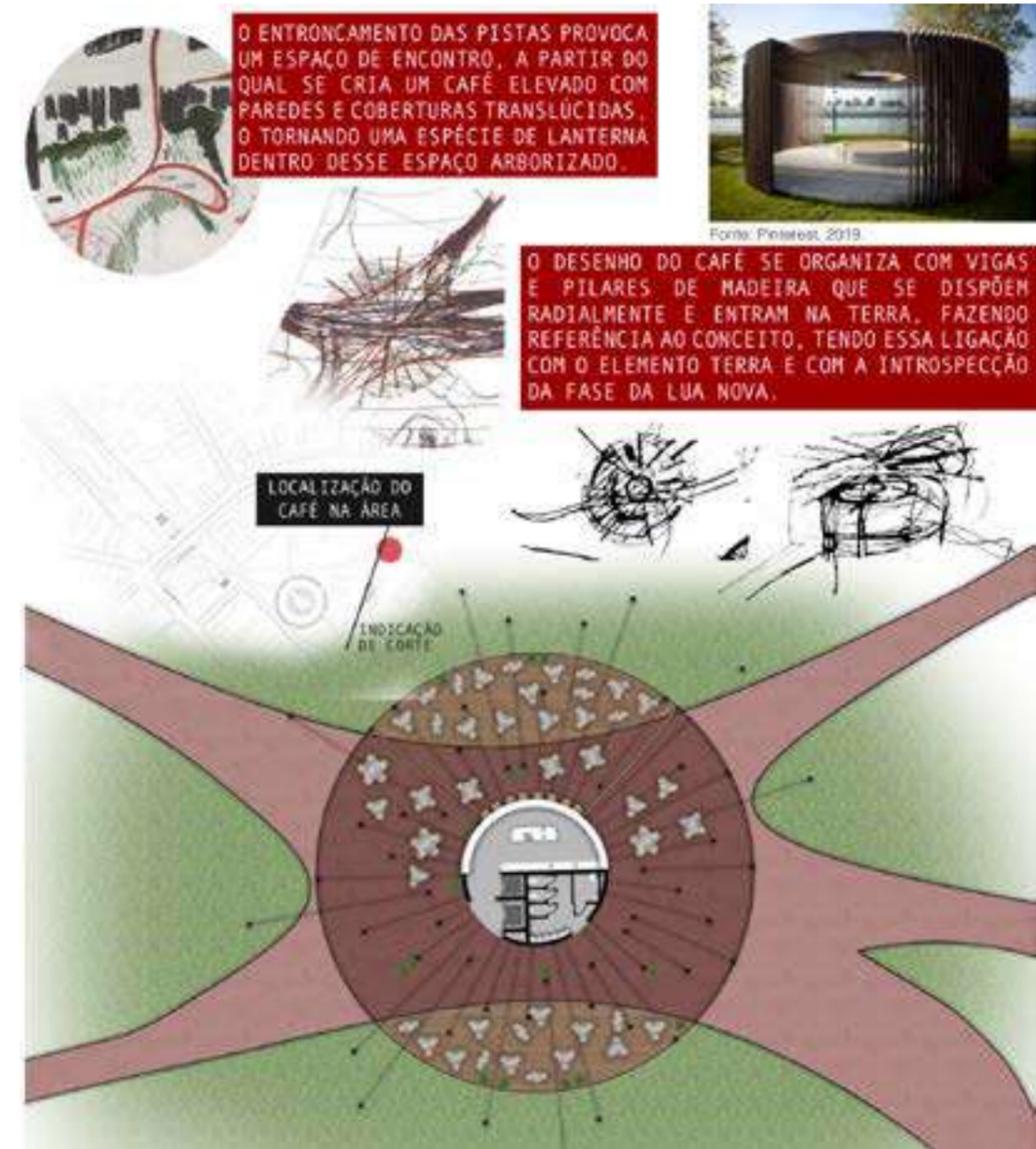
concepção, referências e planta baixa do café e decks do parque. Fonte: da autora.
